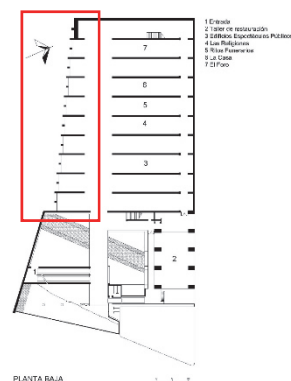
Planta baja, muro sur (Dibujo por el autor).
